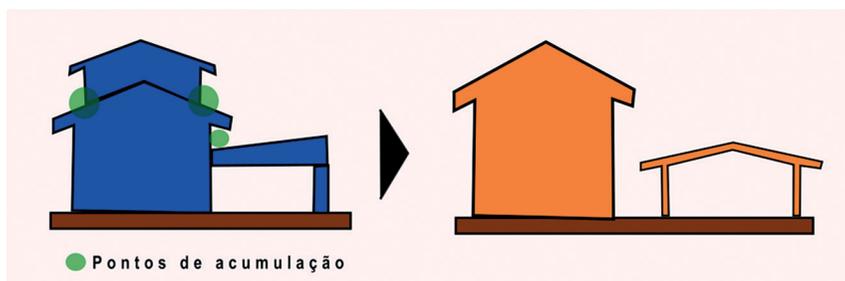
Remoção de transições entre paredes e outros elementos de construção.
